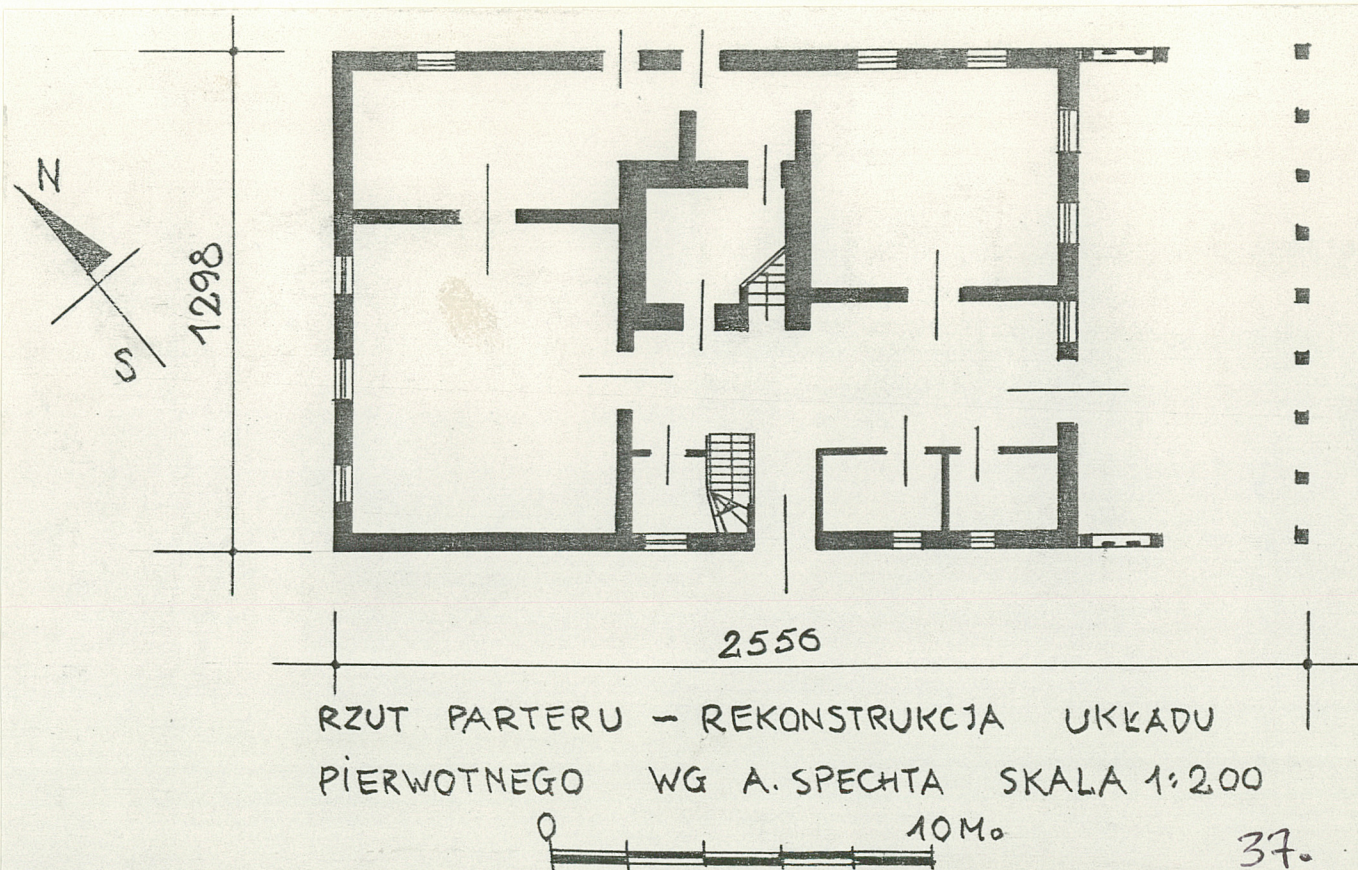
Ergänzung des älteren Grundrisses zu Abb. 111.
